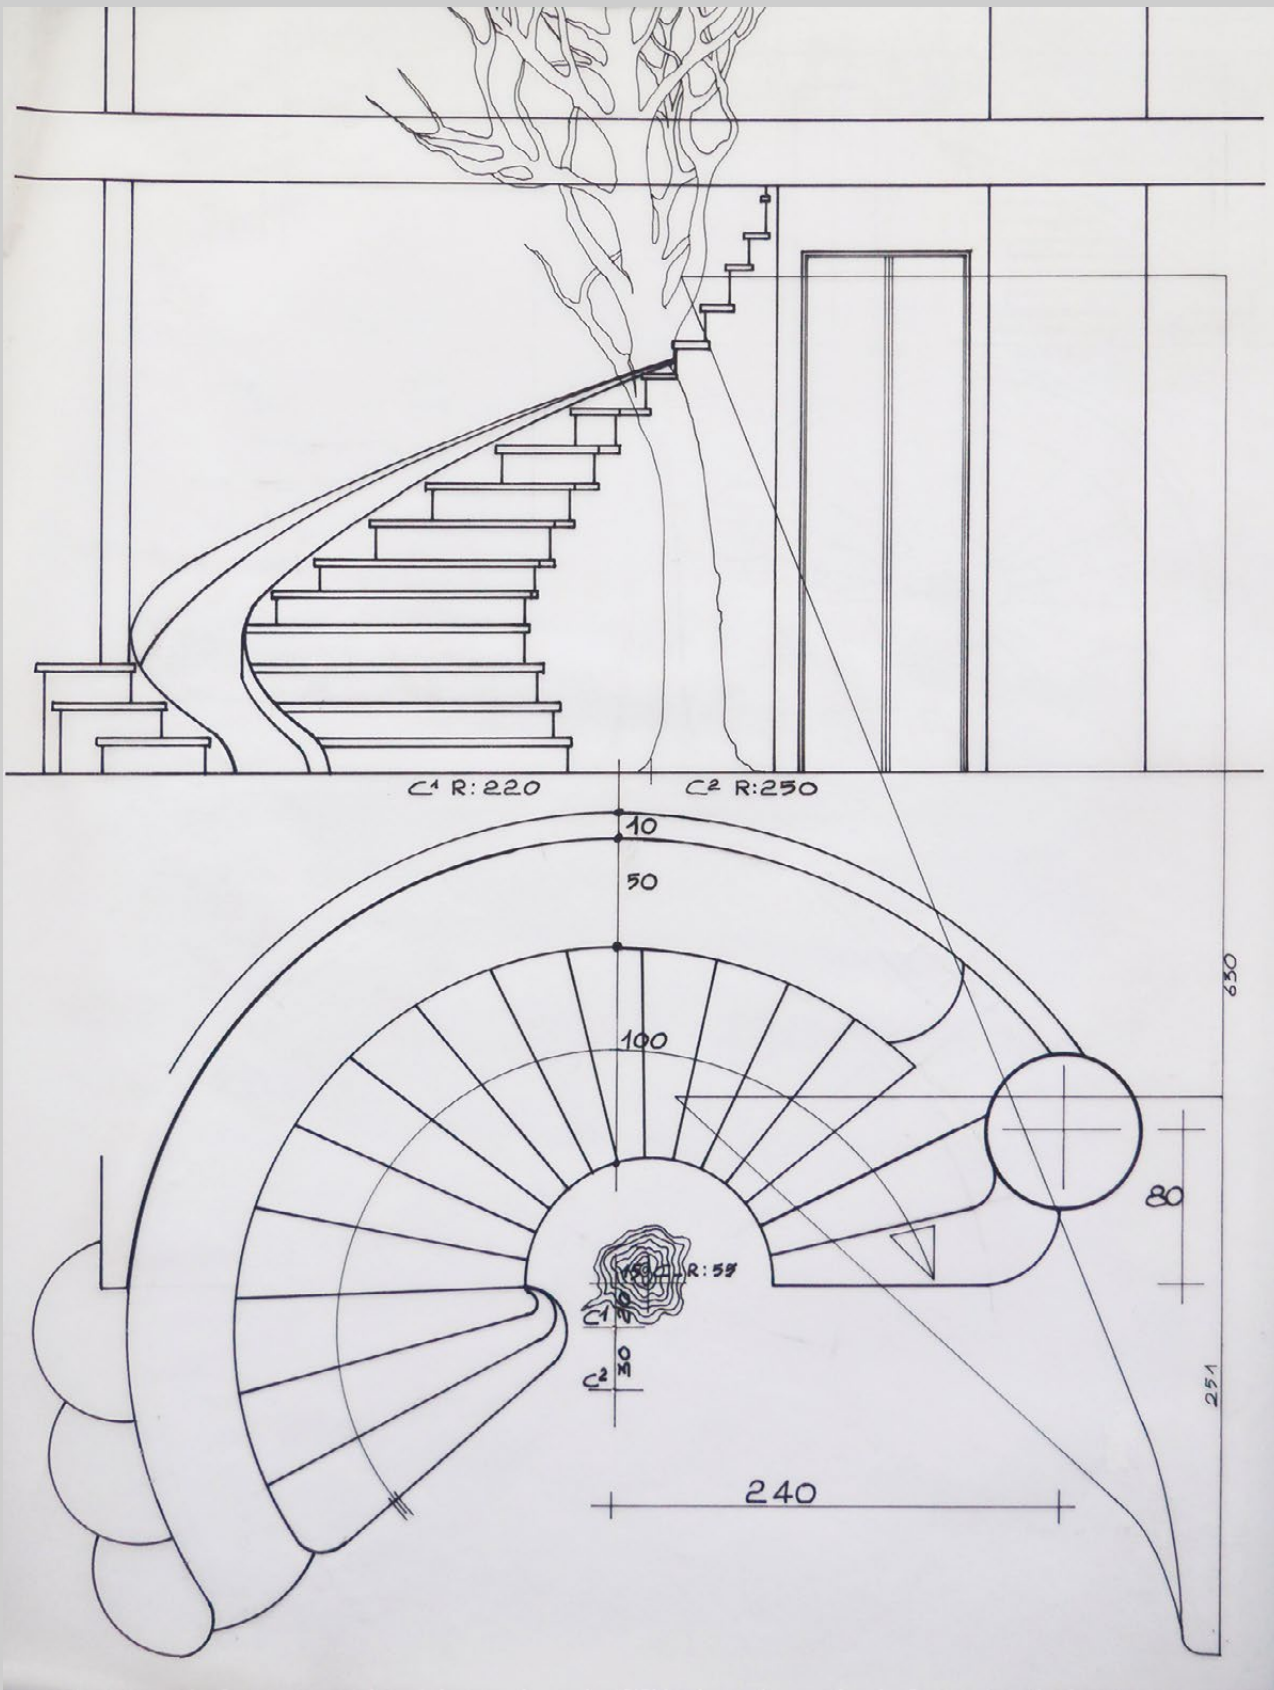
Schizzi per un alloggio a Bardonecchia, su planimetria di cantiere, 2007.
